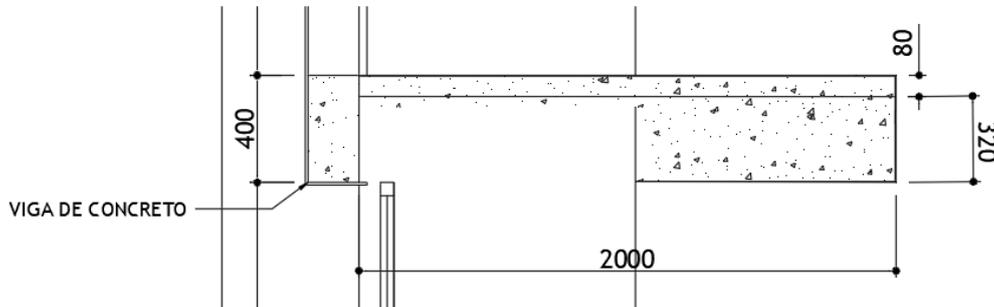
Corte central da marquise em concreto dimensionada no TQS
